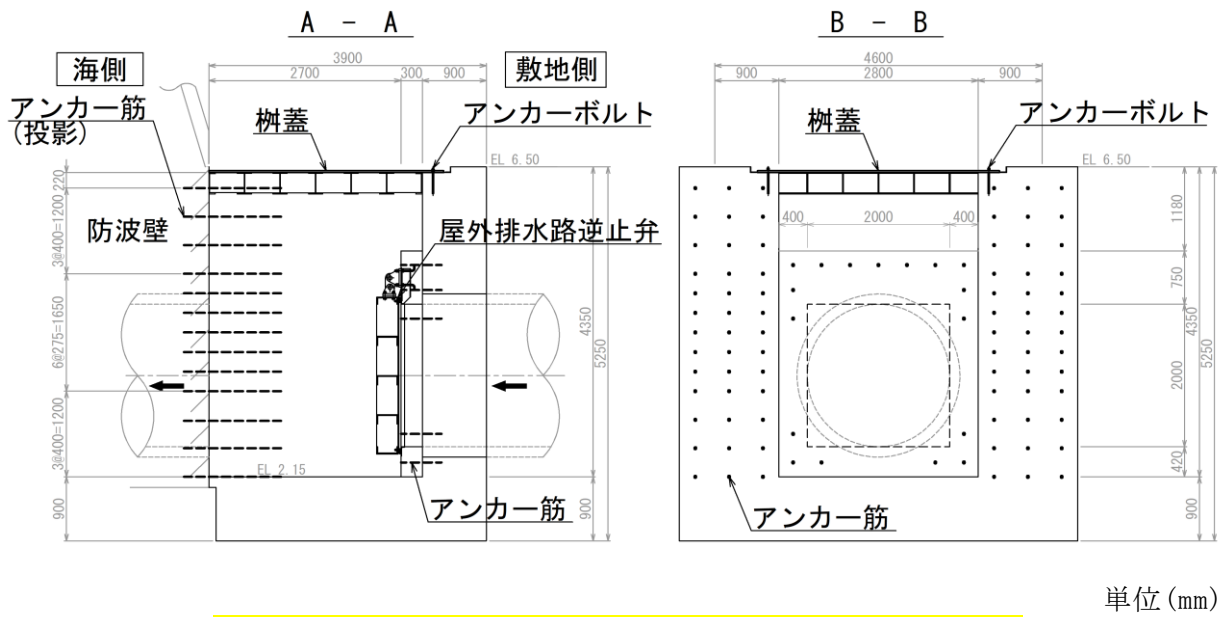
(4) 屋外排水路逆止弁①集水桝構造図 (断面図)
